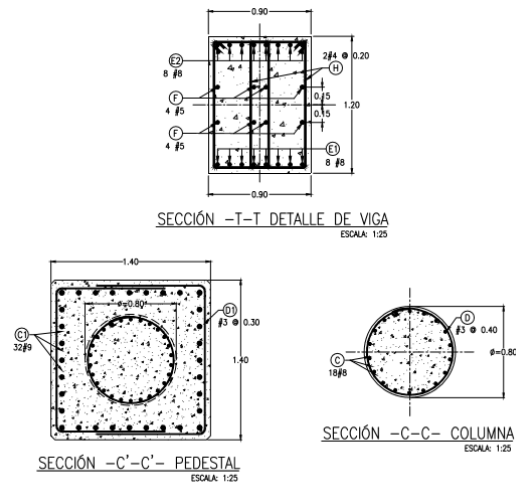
Detalles de viga cabecera, columna y pedestal, 2da calle.
